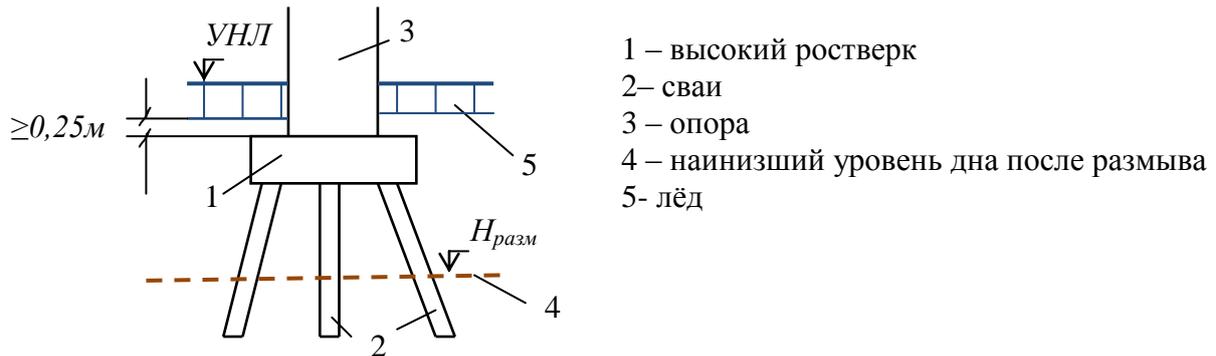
Фундамент с наклонными сваями и отметкой верха ростверка ниже уровня низкого ледохода
